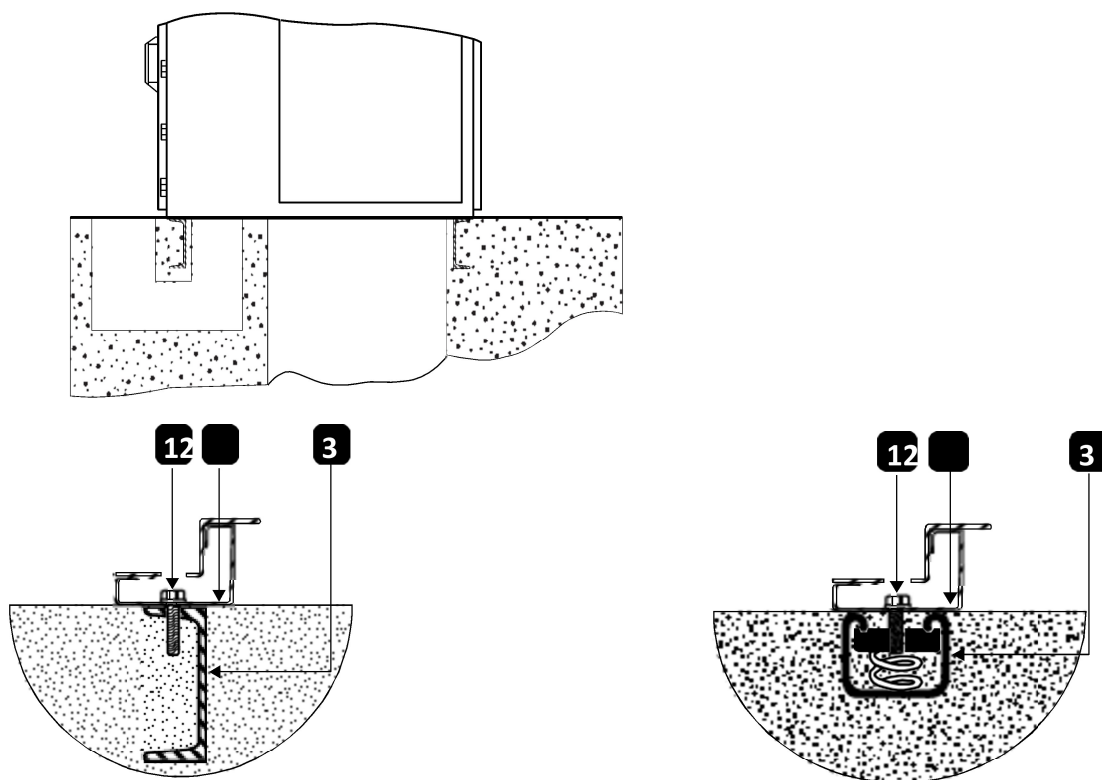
Монтаж УПП на бетонный пол, где
